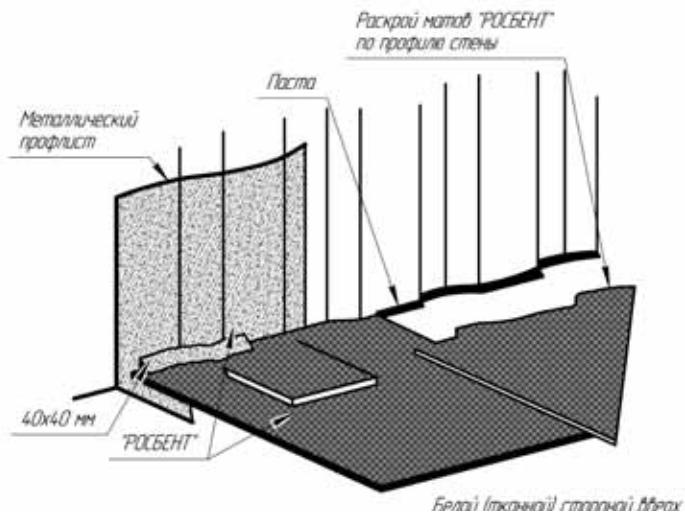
Укладка матов «Росбент» на стену из профлиста
